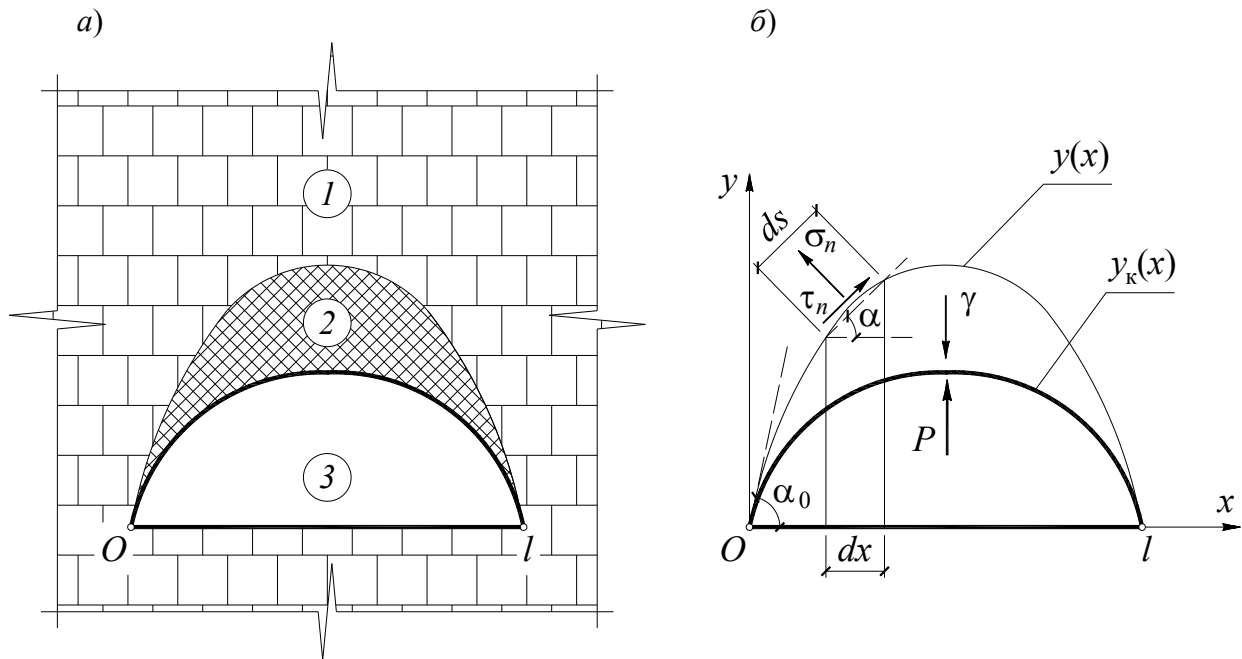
Свод обрушения над калоттой: а – принципиальная схема (1 – грунтовой массив, 2 – свод обрушения, 3 – калотта); б – расчетная схема
